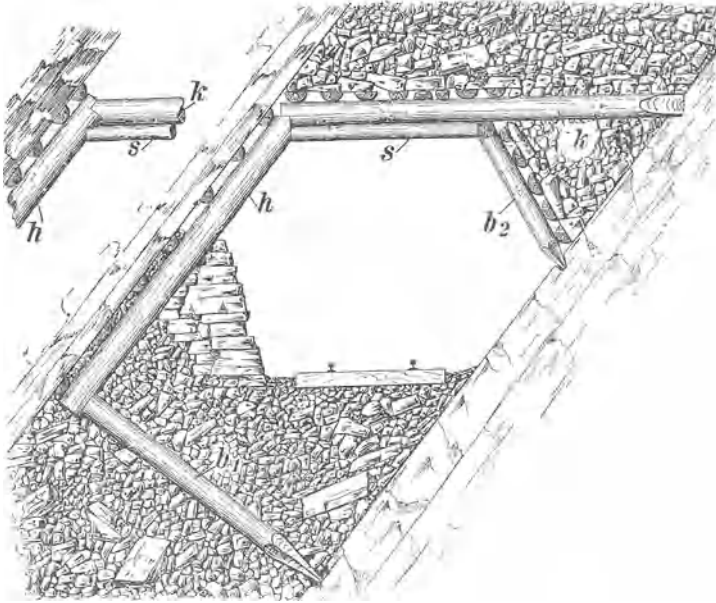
Nachgiebiger Schalholzausbau mit Sprengwerk in Strecken.
